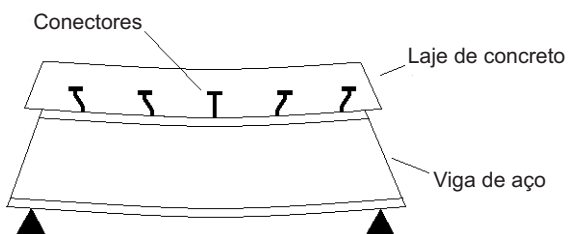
Configuração deformada de uma viga mista simplesmente apoiada sob ação de cargas gravitacionais.
